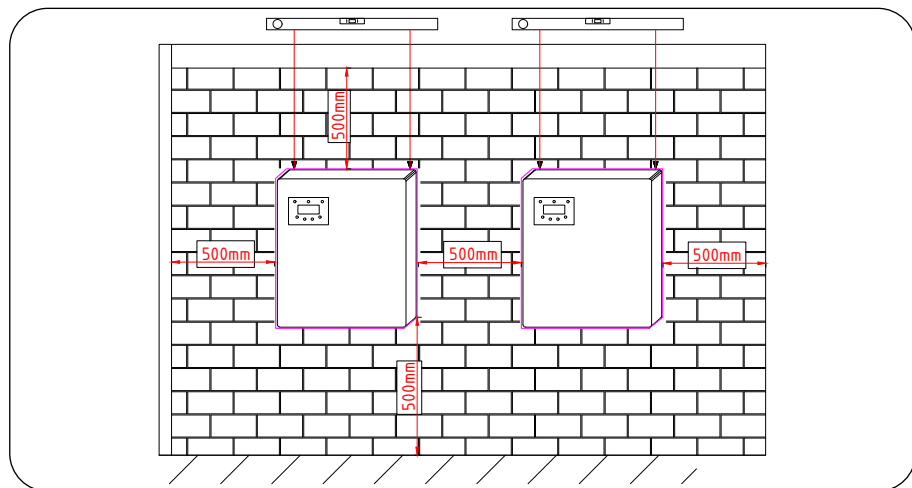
Spazio di installazione dell'inverter (distanze minime), vista frontale
